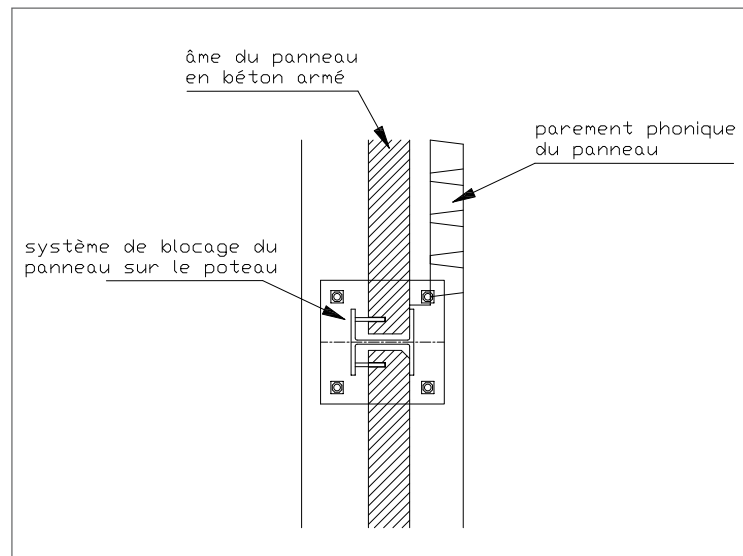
Détail de la liaison panneau/poteau - Système de calage
